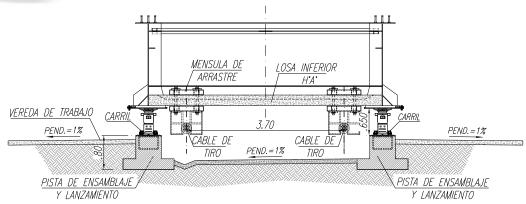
Sección transversal de pista de ensamblaje y lanzamiento
